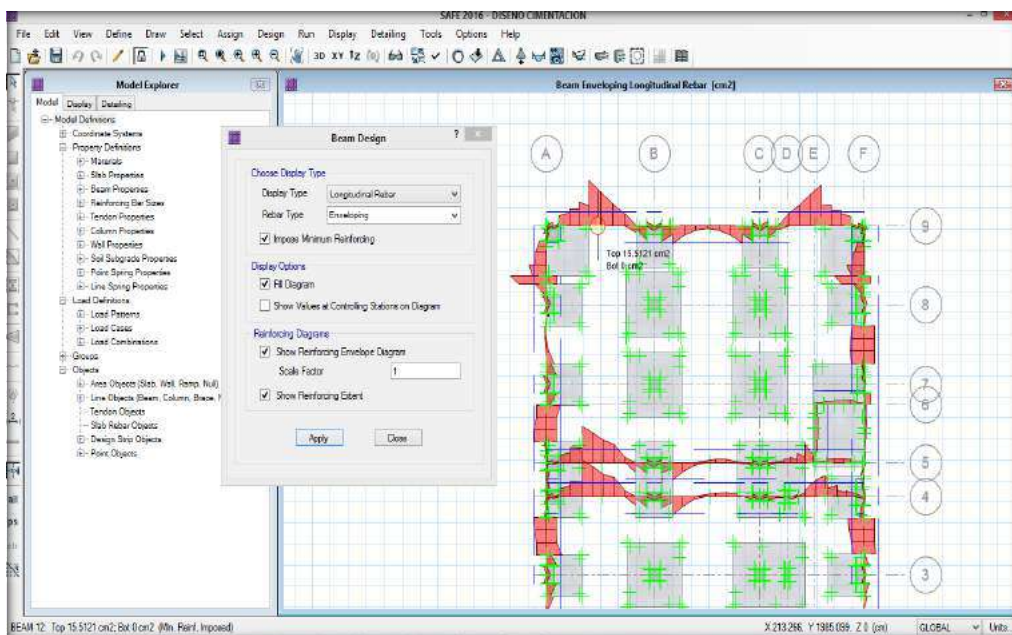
Se obtuvo el diseño de acero para la viga de cimentación del refuerzo longitudinal.
